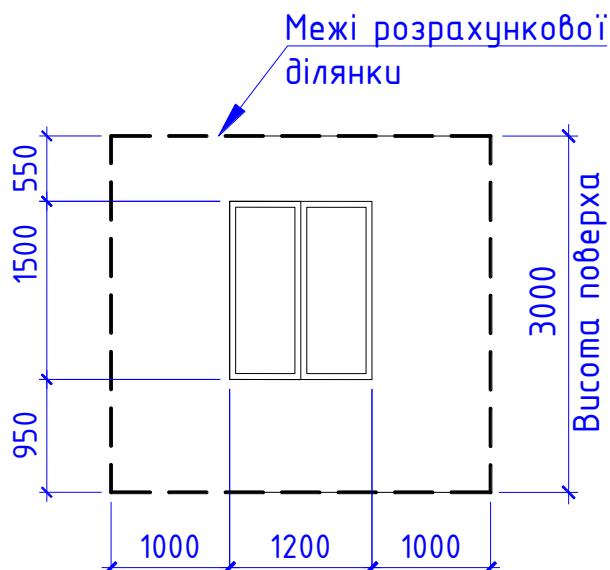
Фрагмент фасаду з розрахунковою ділянкою
